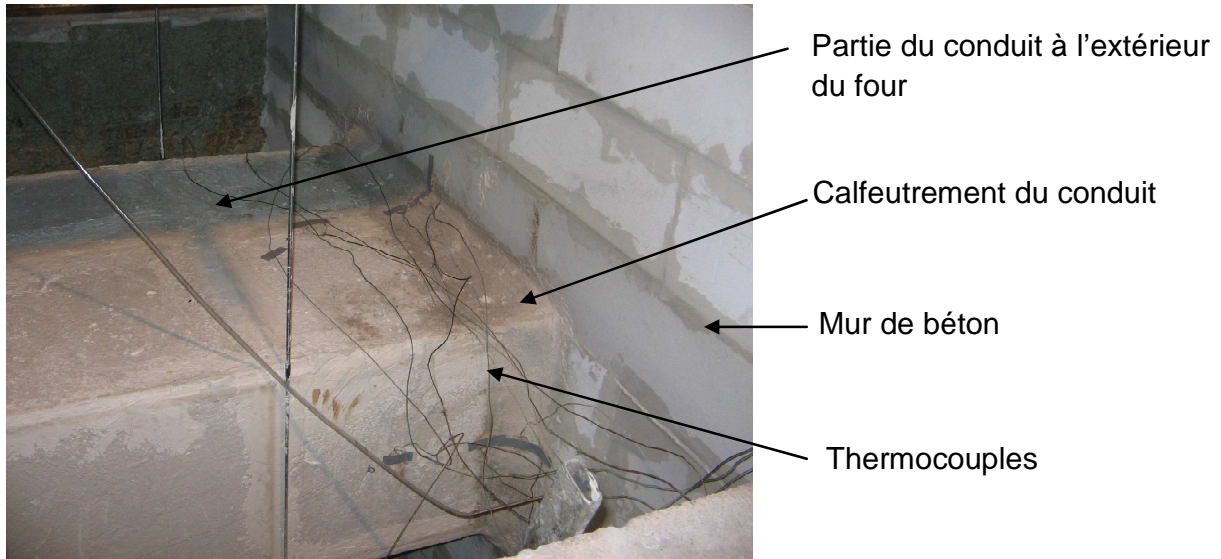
Photo des thermocouples placés au niveau du calfeutrement du conduit.
